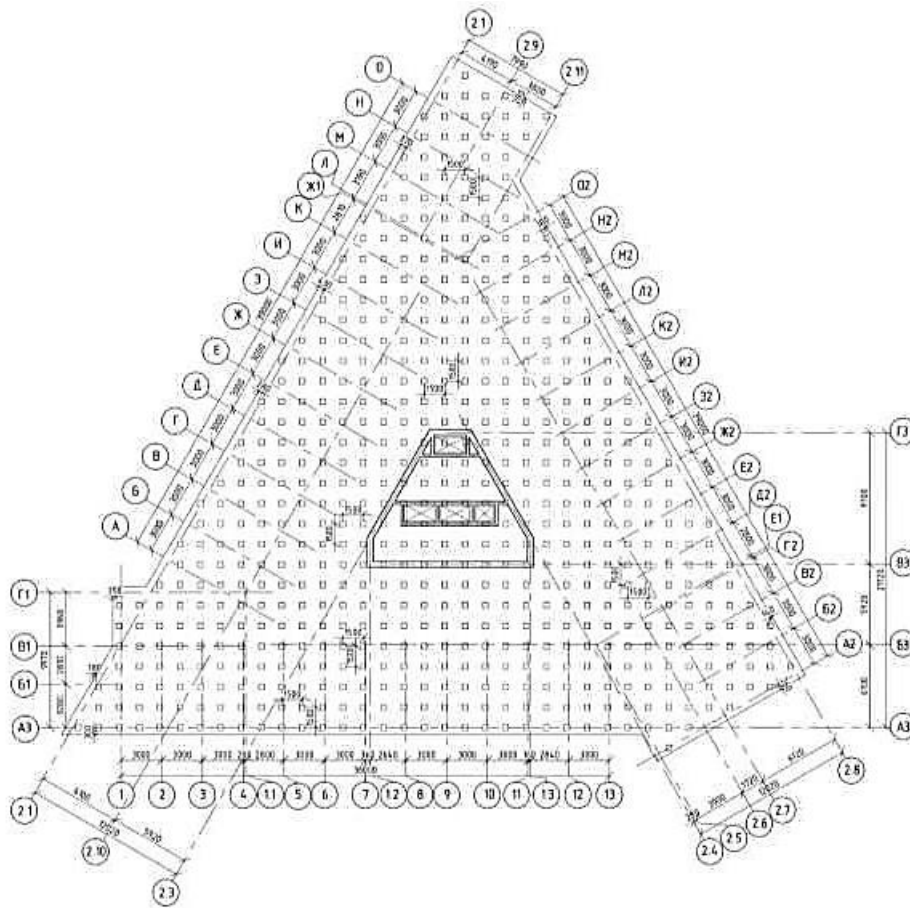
Опалубне креслення монолітної плити фундаменту.
